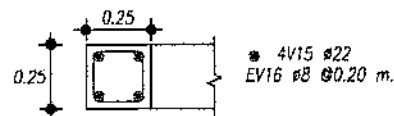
Area de acero de refuerzo en vigas de losa  $e=25\text{ cm}$ .
